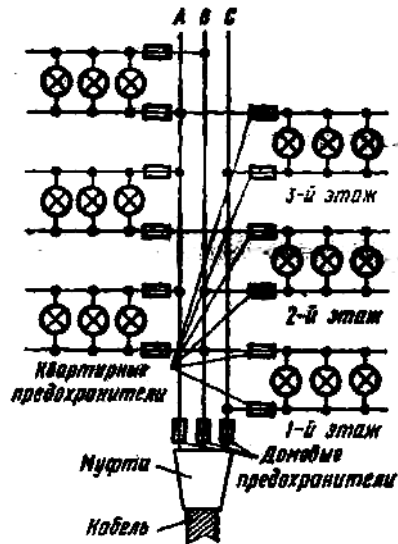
Схема трехпроводной осветительной сети при соединении фаз нагрузки треугольником
